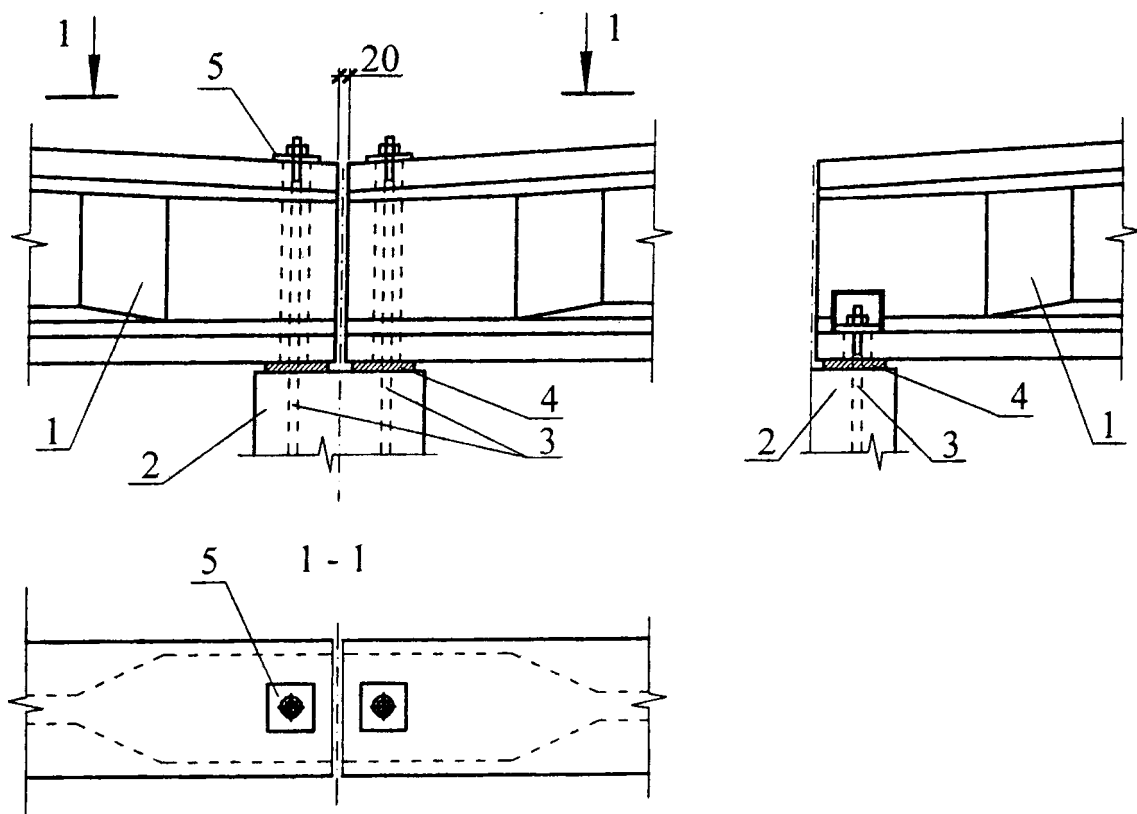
Варианты узлов сопряжения двутавровых балок с колонной:
